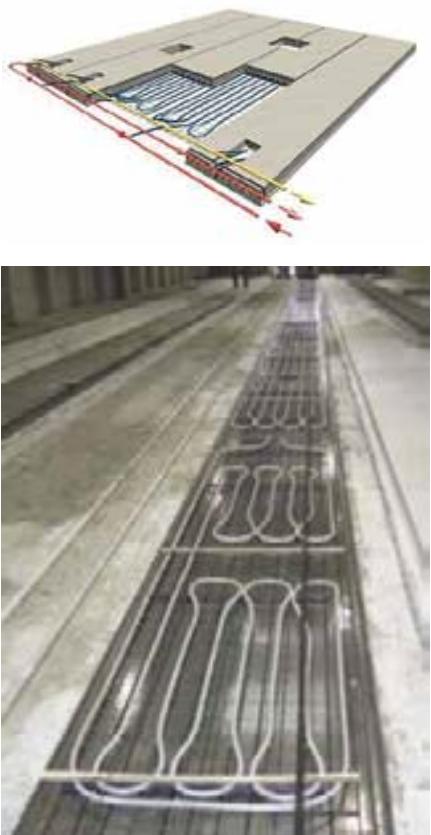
Holle vloeren met ingebetonneerde waterleidingen voor verwarming en koeling
